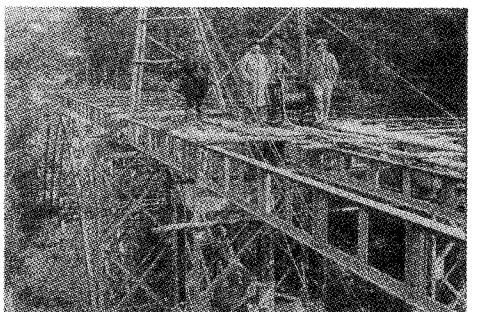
氷川大橋縦桁 (鋼桁) 架設状況
